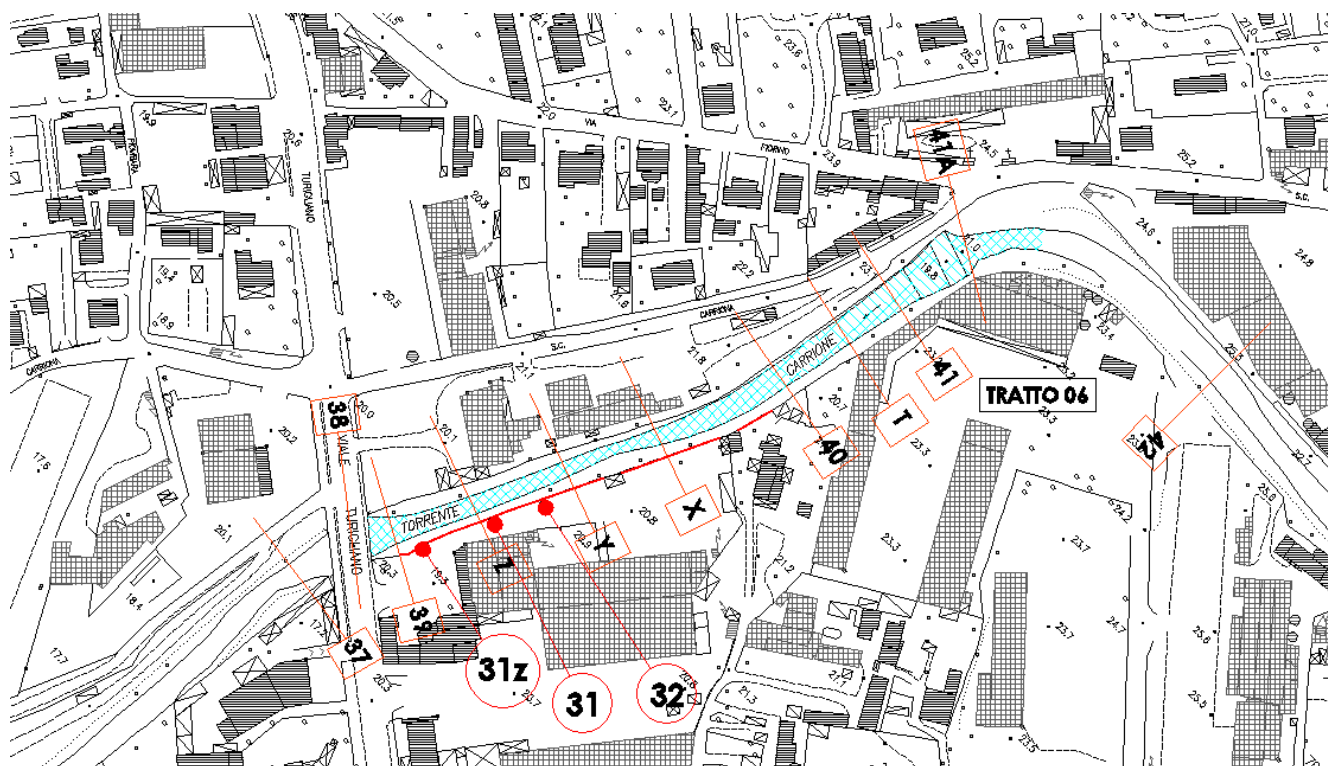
Inquadramento planimetrico – Tratto 06 – Sponda sinistra
